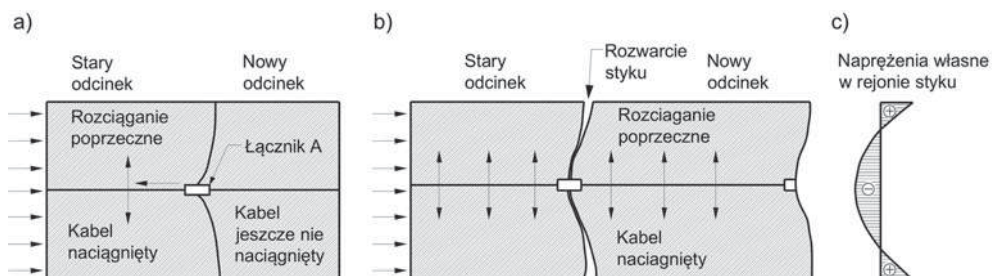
Idea wykonywania konstrukcji w przypadku kotwienia wszystkich kabli na czole wykonanego segmentu
